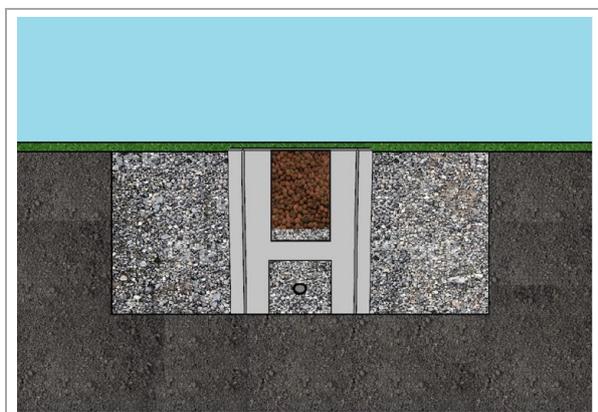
Riempire lo scavo di fondazione con il materiale di sterro
